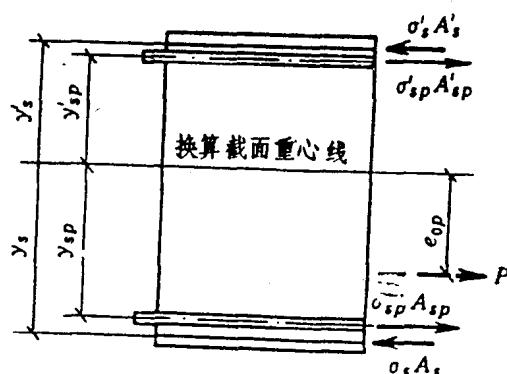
钢筋混凝土构件横截面上钢筋中的预应力简图
